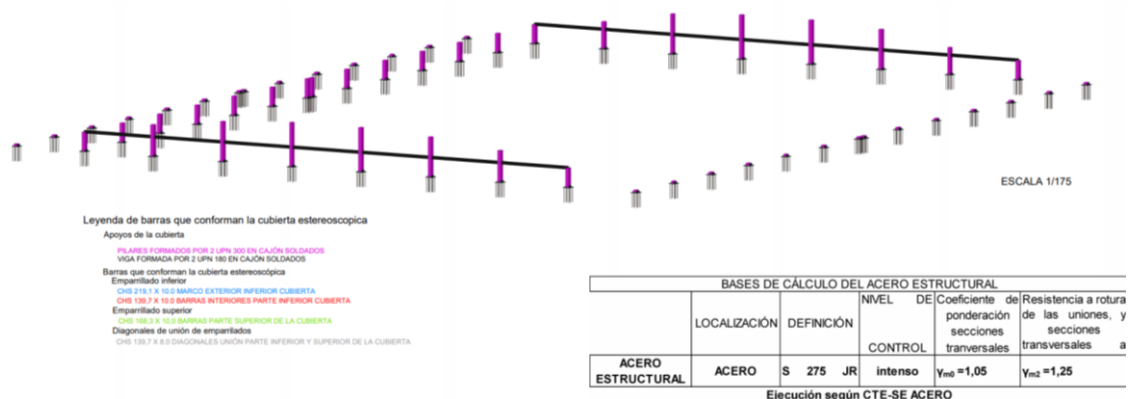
Disposición de pilares y viga metálicos en la estructura de hormigón.
